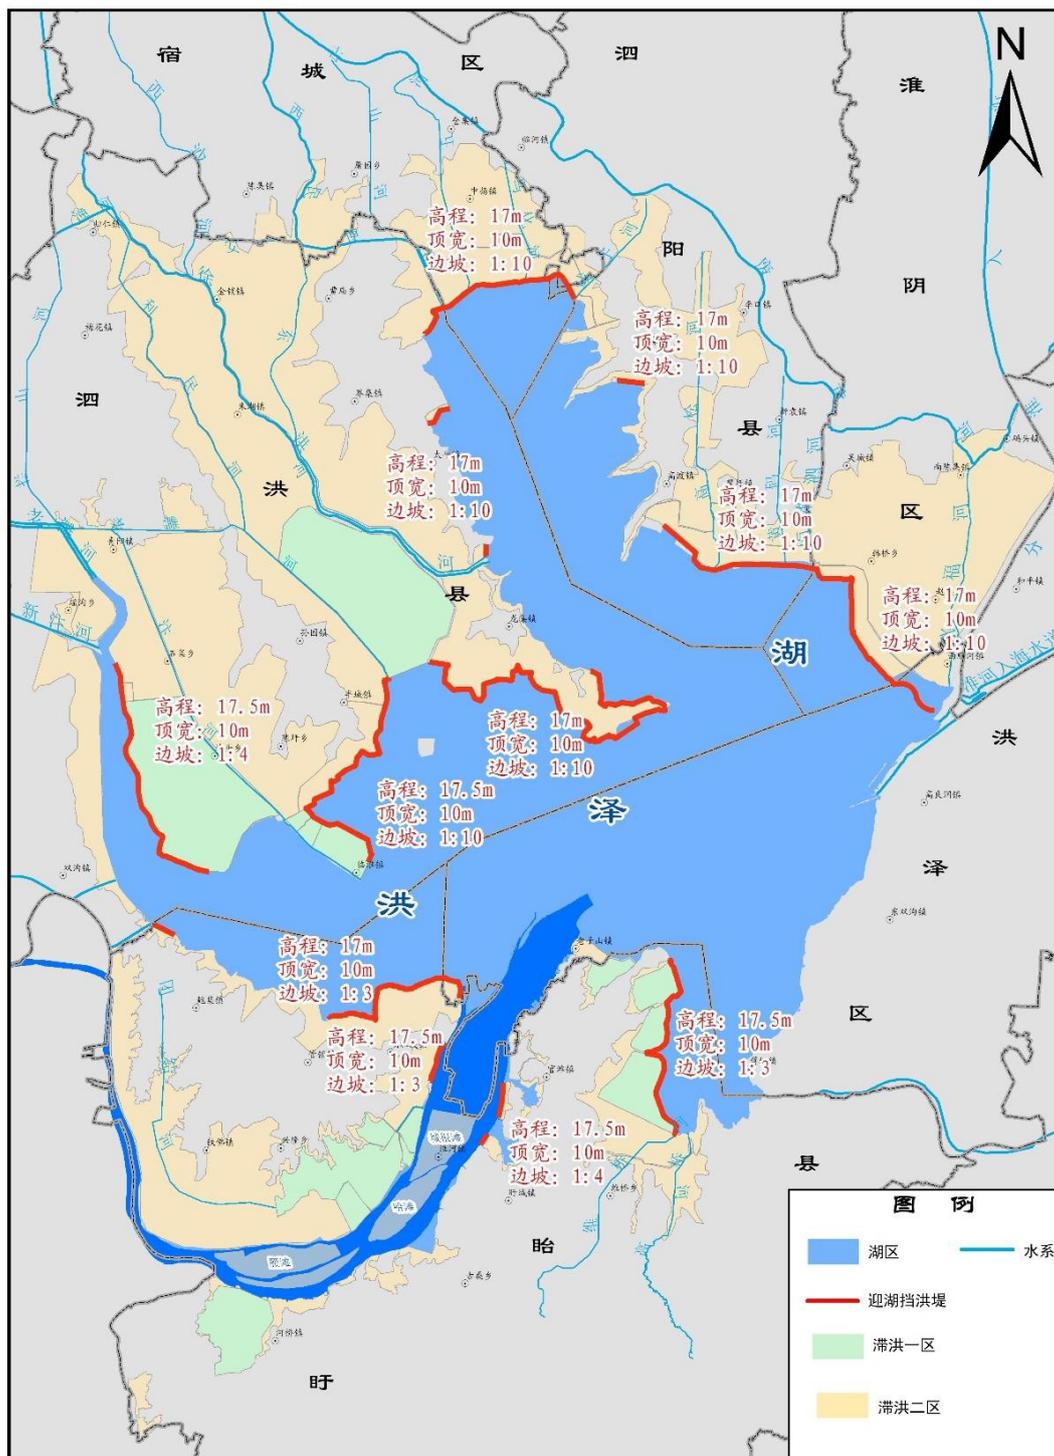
10m 顶宽迎湖挡洪堤布置图
